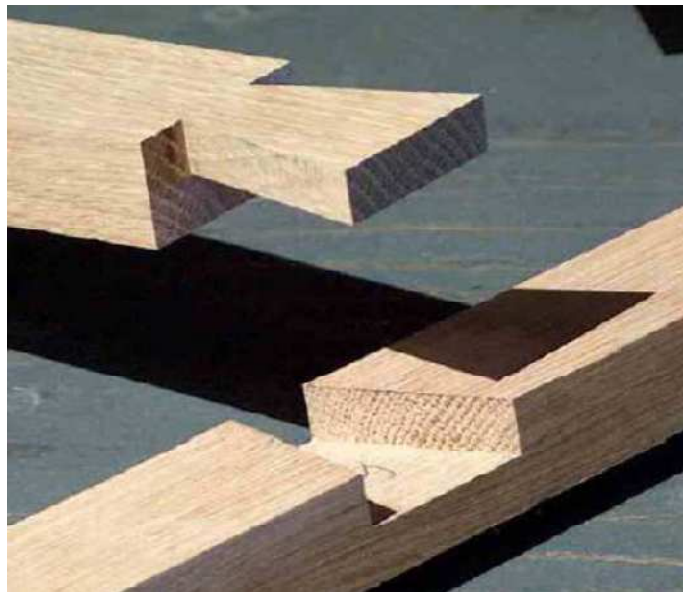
Ensamble en cola de milano (fuente: Scribd.com)
